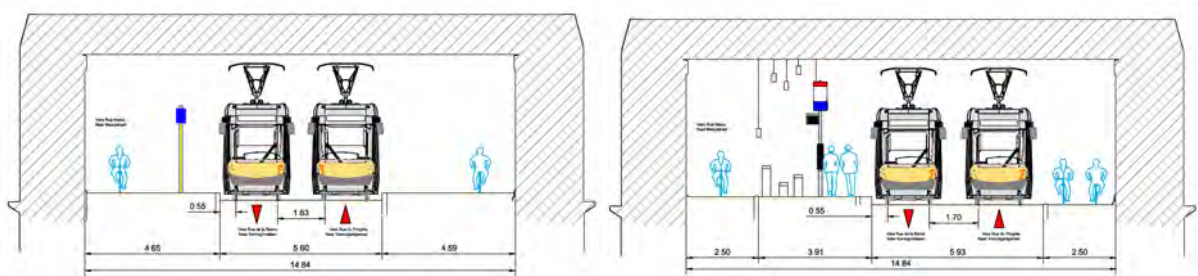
Coupe du tunnel Thomas : situation existante (à gauche) et situation projetée (à droite) (Bruxelles Mobilité, 2019)
